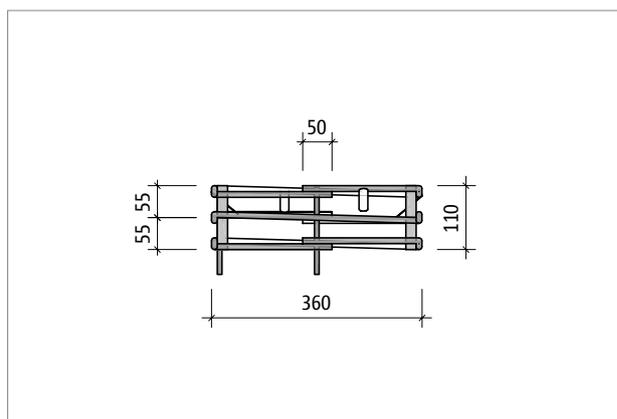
Schöck Sconnex® type P-B400 : vue latérale Part T; étrier soudé et segments flexibles en acier inoxydable
